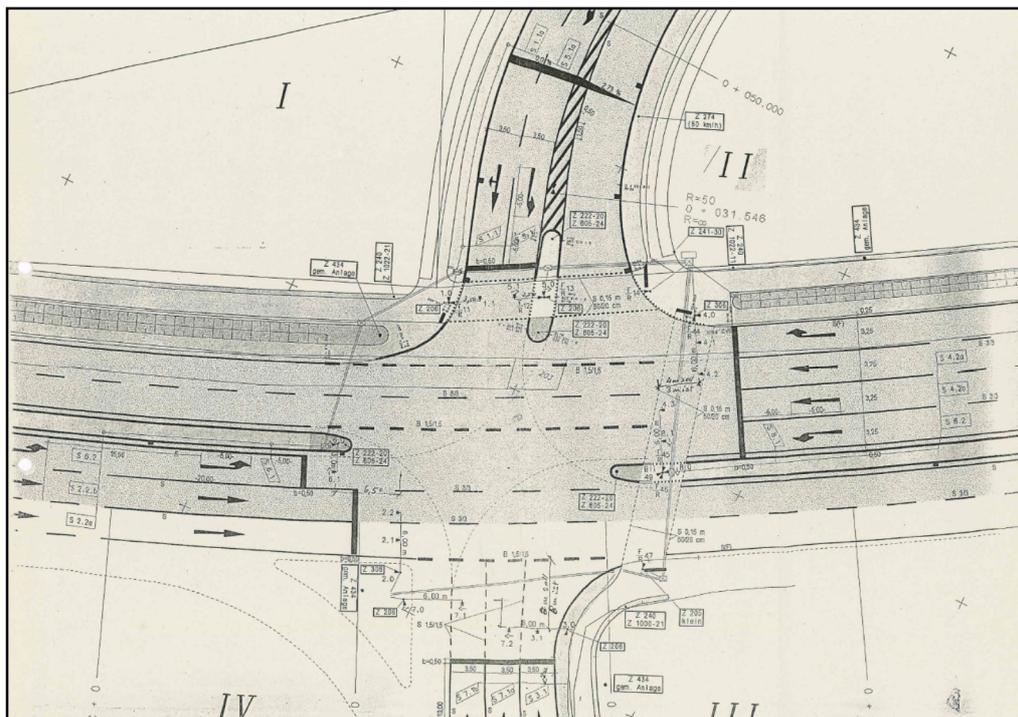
Lageplan Knotenpunkt B51 / Kiebitzpohl
